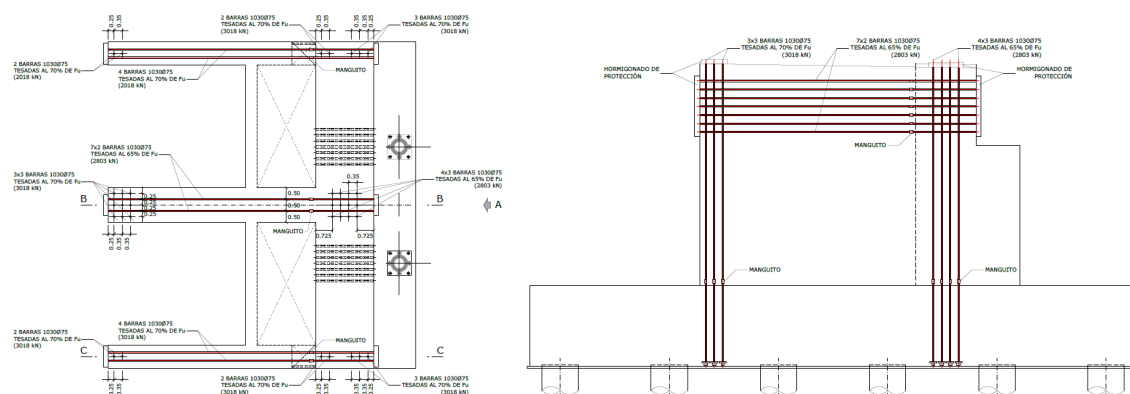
Planta y sección por contrafuerte en estribo fijo del Viaducto sobre la Rambla de Galián
